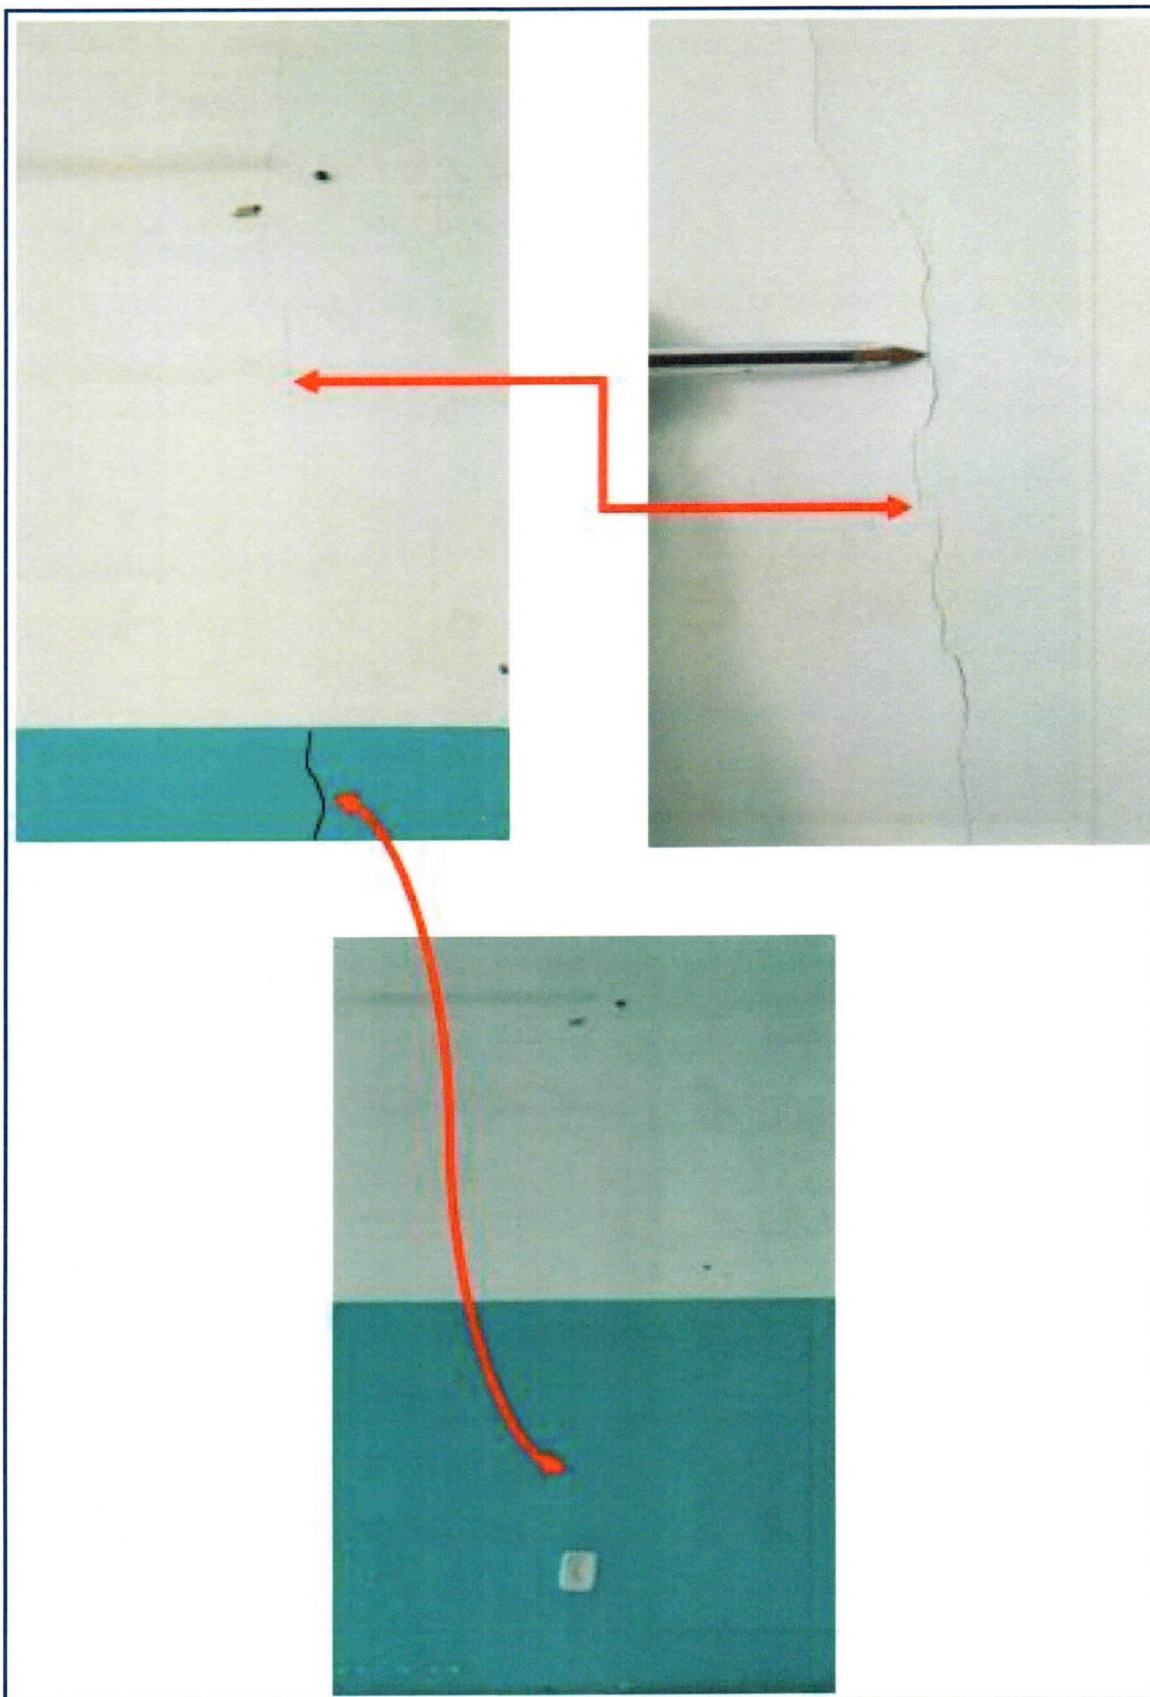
Vista da fissura na parede de alvenaria nos fundos da sala, junto a esquadria de ferro, em decorrência de movimentação da estrutura nessa interface.
